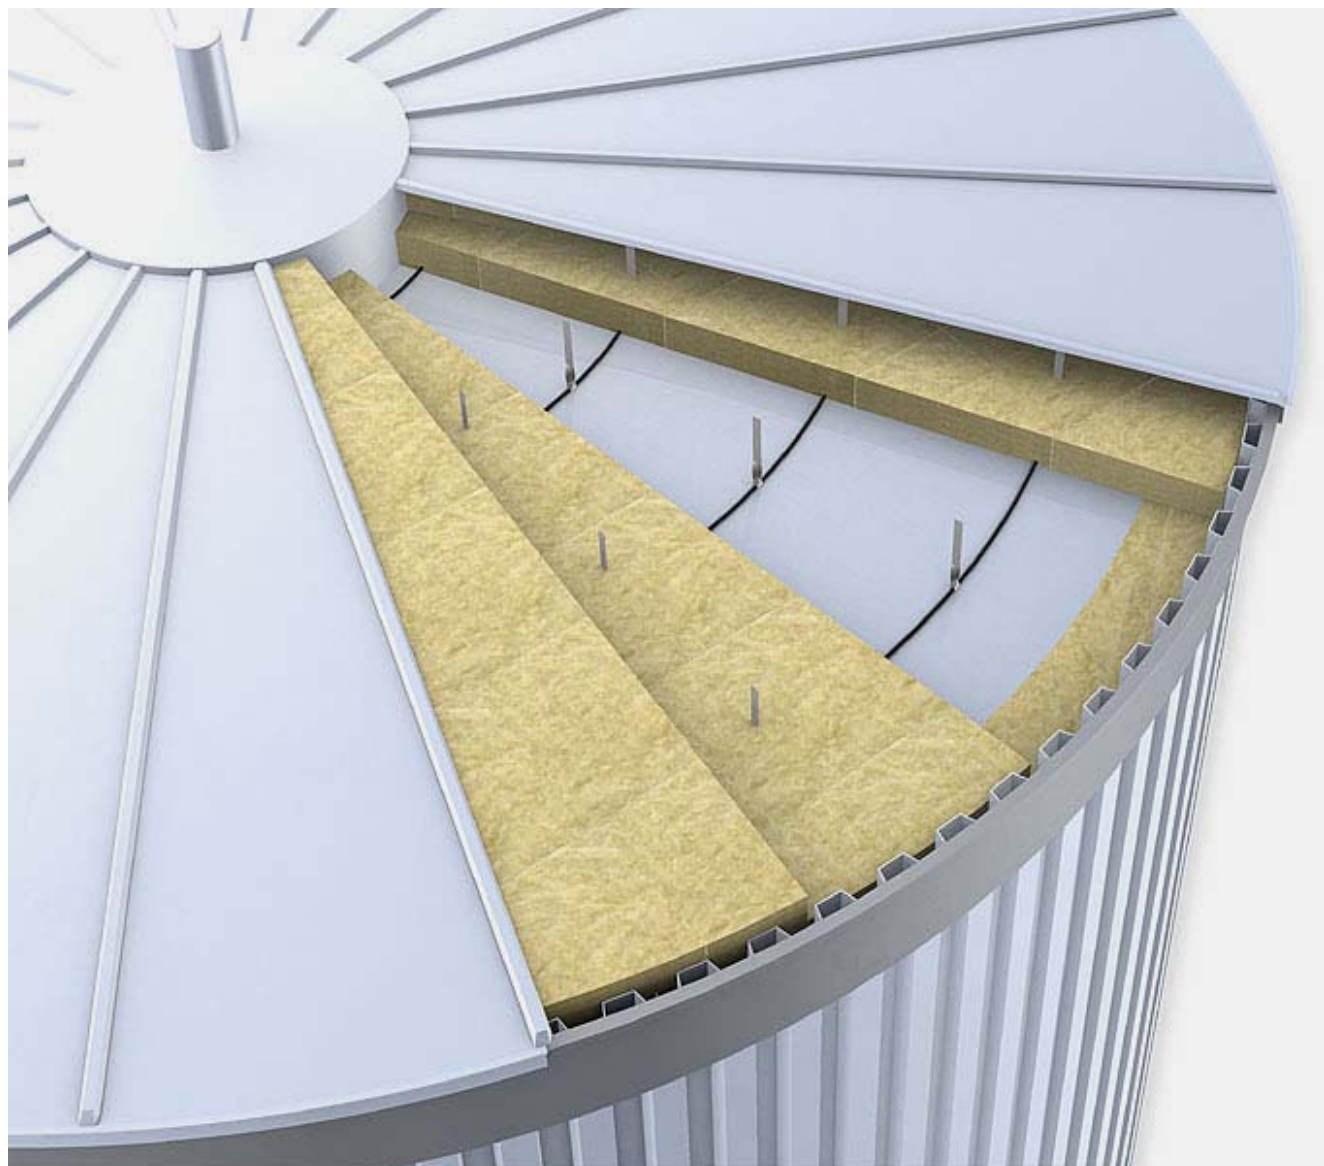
а. Устройство кровли изолируемого резервуара, где опорная конструкция находится сверху плиты кровли резервуара.
